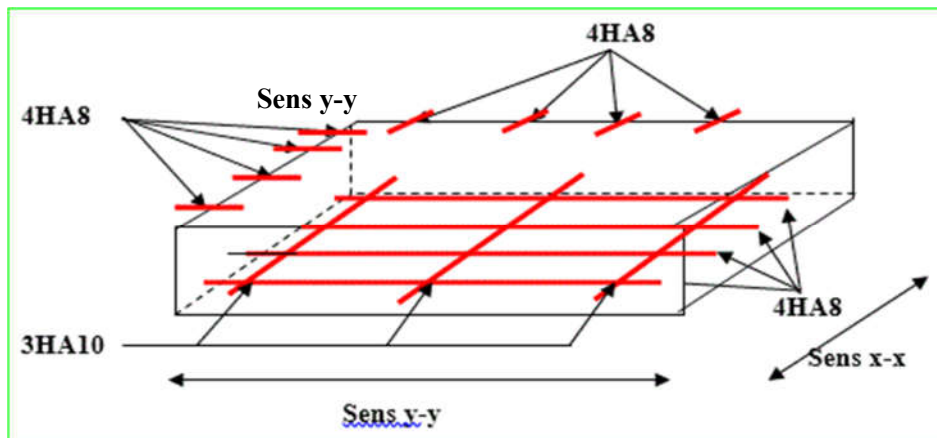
Schéma de ferrailage de la dalle pleine du local machinerie.
